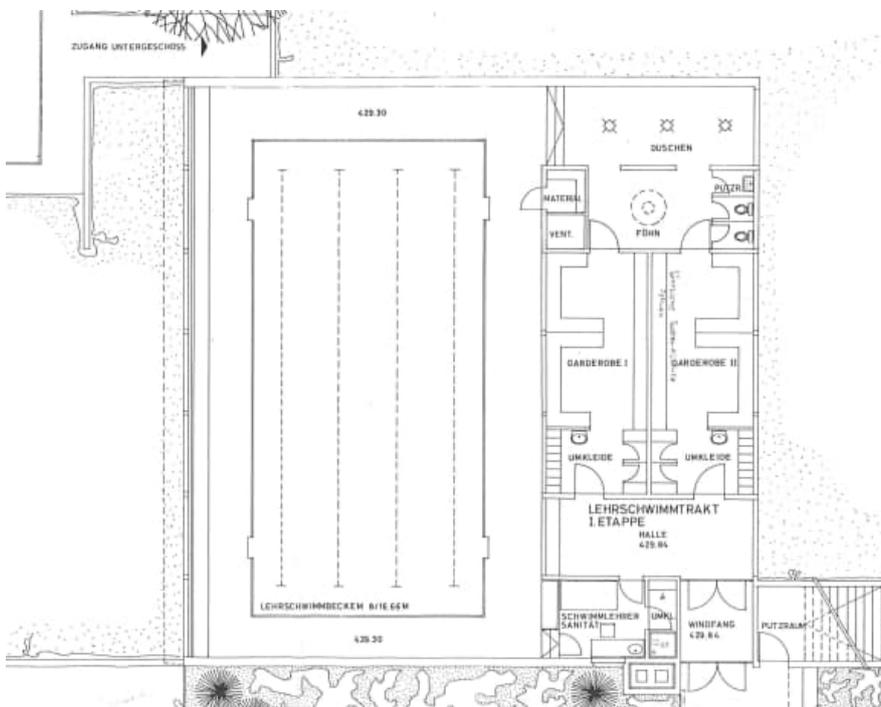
Planskizze «Grundriss Erdgeschoss» Lehrschwimmtrakt
